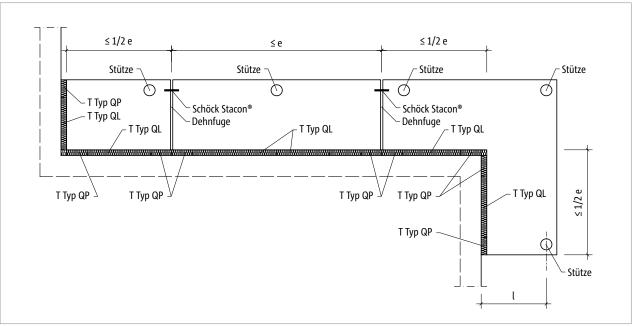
Schöck Isokorb®: Dehnfugenausbildung mit längsverschieblichem Querkraftdorn, z. B. Schöck Stacon®
